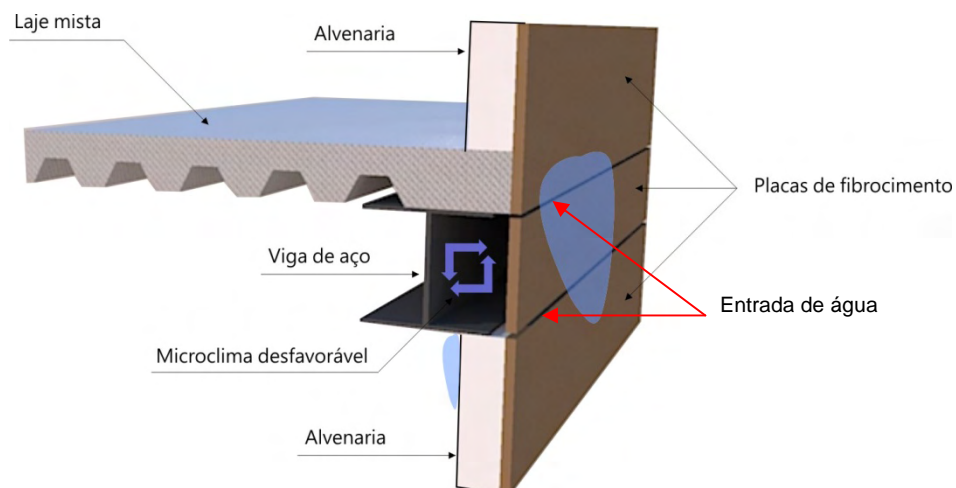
Detalhe do revestimento das vigas de aço com placas de fibrocimento.
